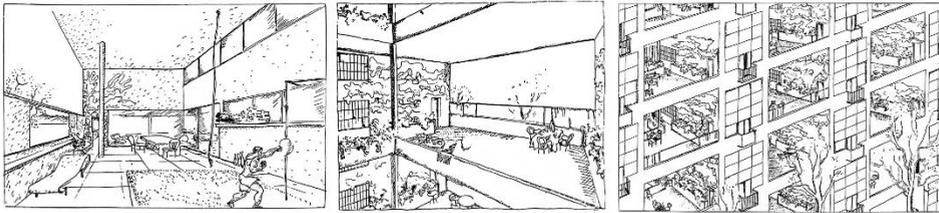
Terrazas elevadas de los Inmuebles Villa, Villa Baizeau, bocetos.
